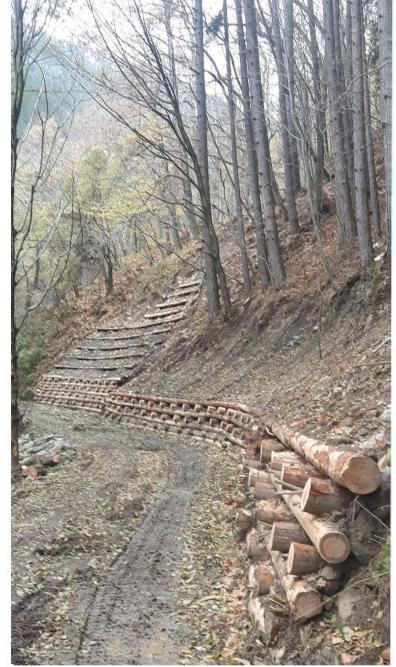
a – Palificata e grata vive con talee a fine lavori, prima dell'inserimento di piante radicate (stato antecedente in Foto n. 2 e 3)
